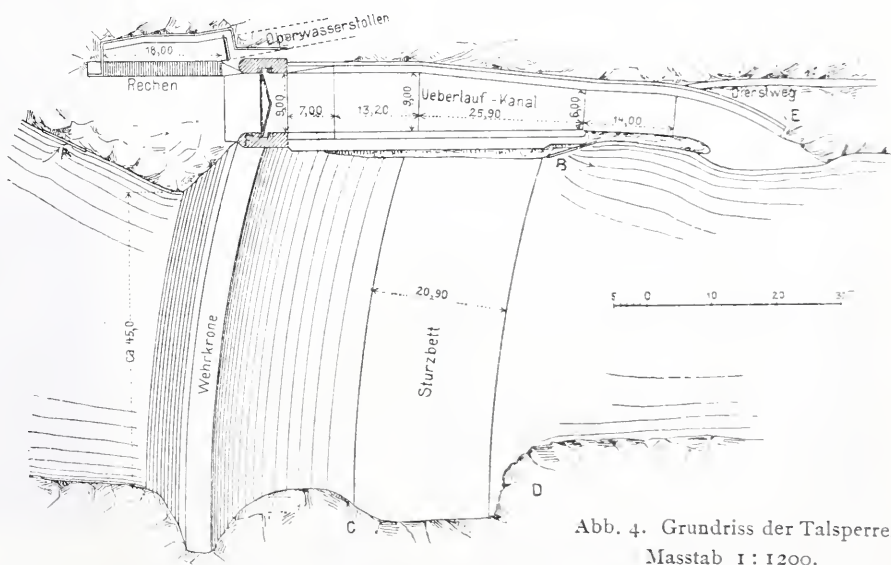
Grundriss der Talsperre. — Masstab 1:1200.
